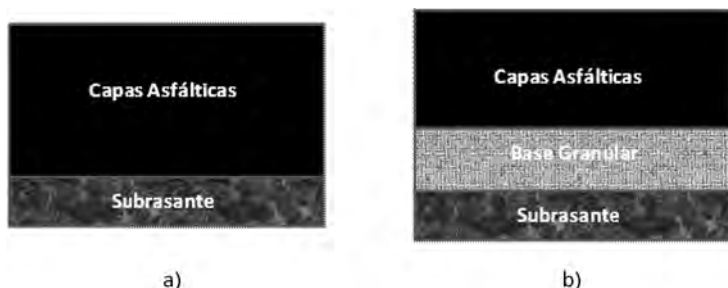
a) Estructura con espesor pleno en concreto asfáltico. b) Estructura de un pavimento con resistencia profunda.
